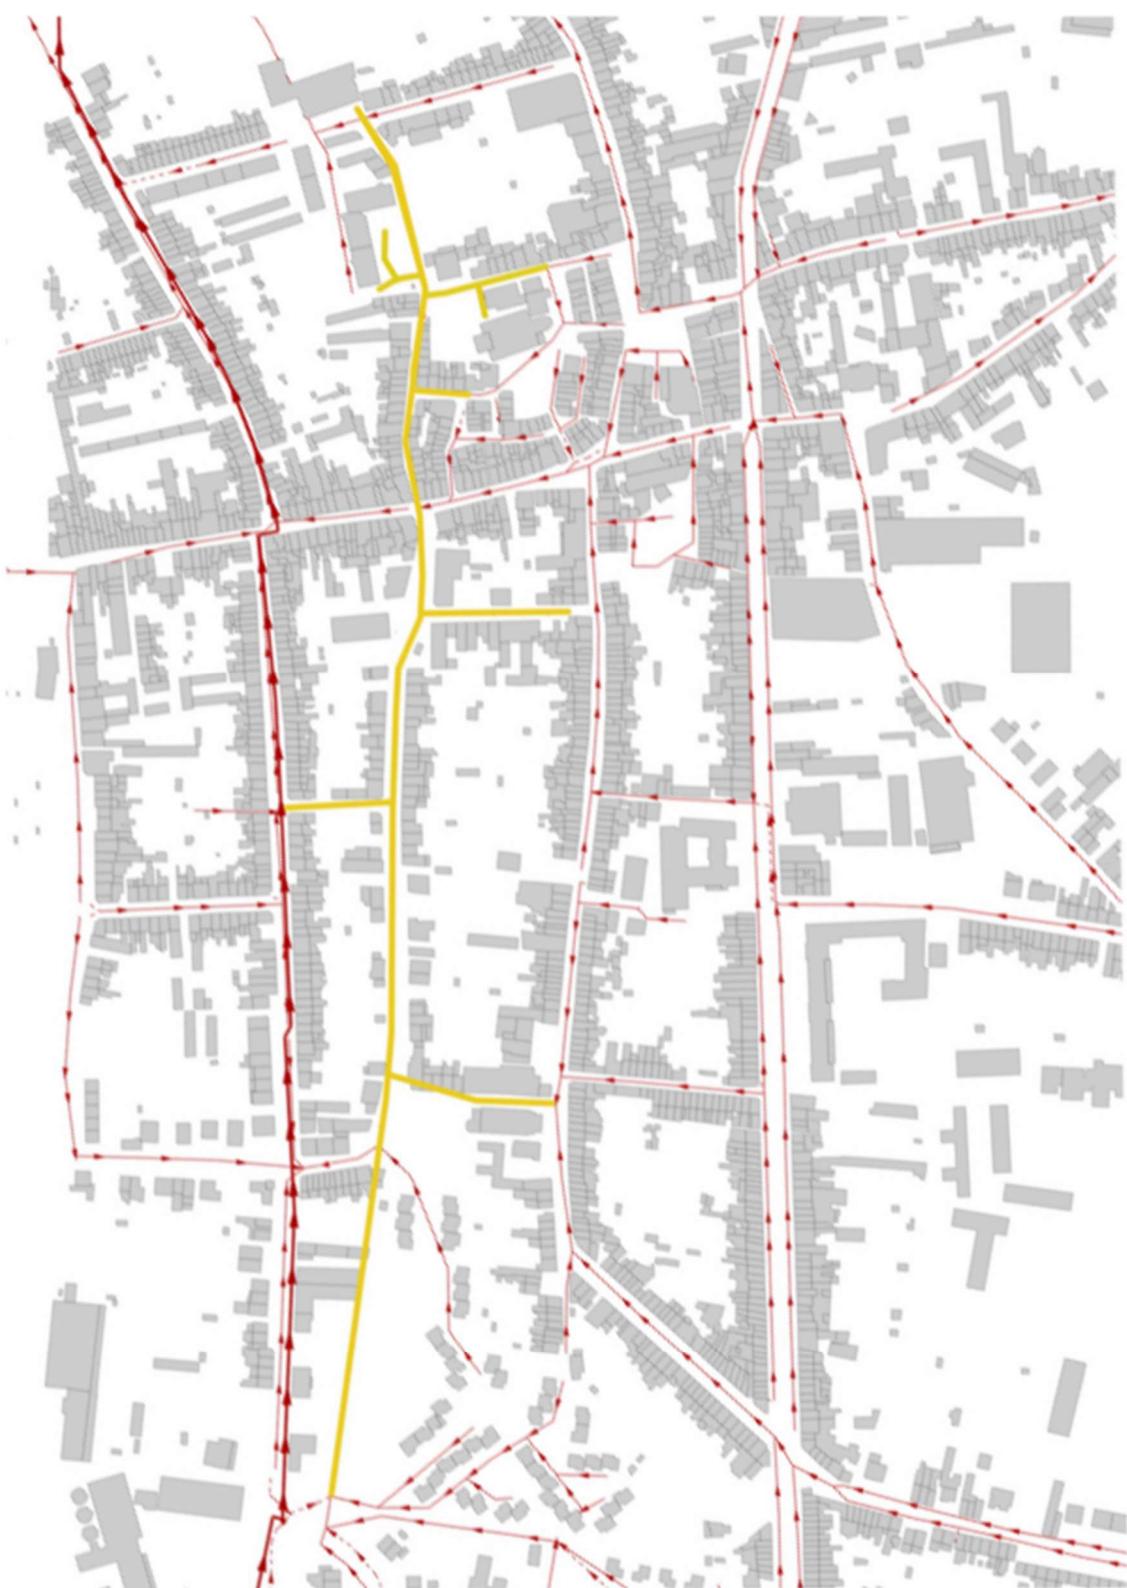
Plan du nouveau réseau d'égouttage. Production de Morgane Bauvir
